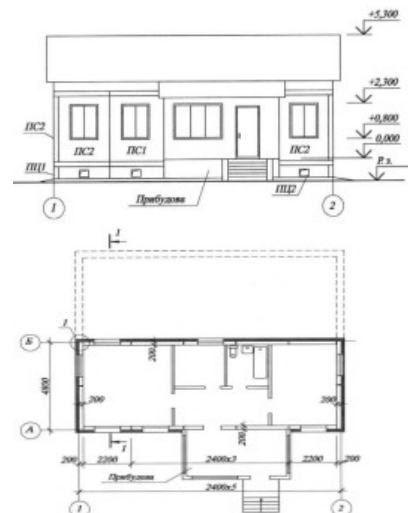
Основні технічні рішення системи «Контур»: а - фасад 1-2, б - план на позн. 0,000 / Basic technical solutions «Circuit»: а – facade 1-2, в - plan at elevation 0,000
